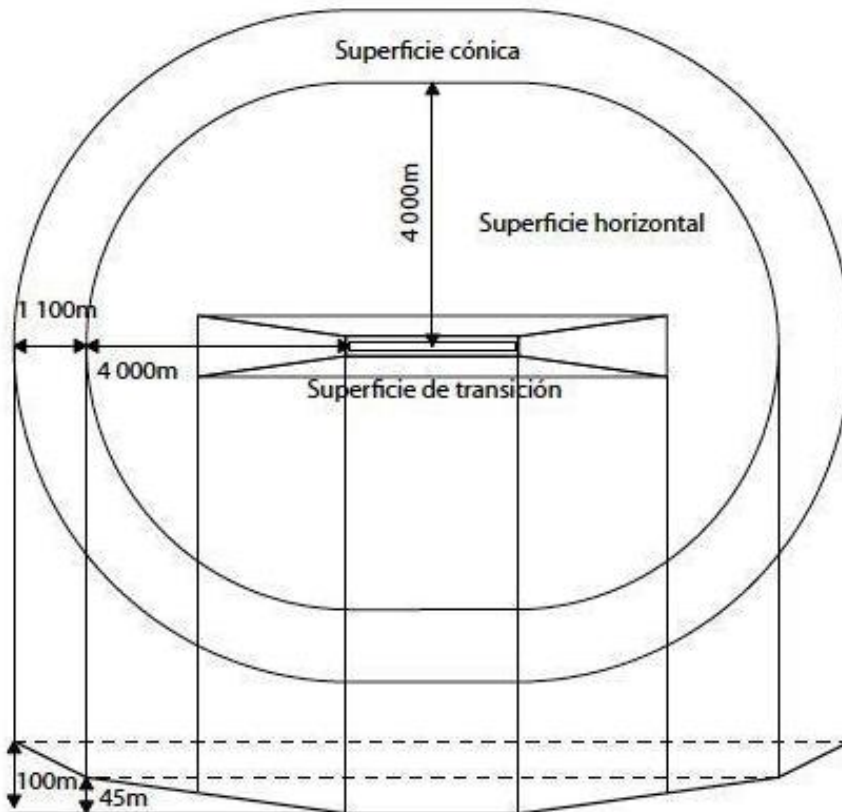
Vista en planta y de perfil de las superficies de transición, horizontal interna y cónica. Fuente: UNAM.
